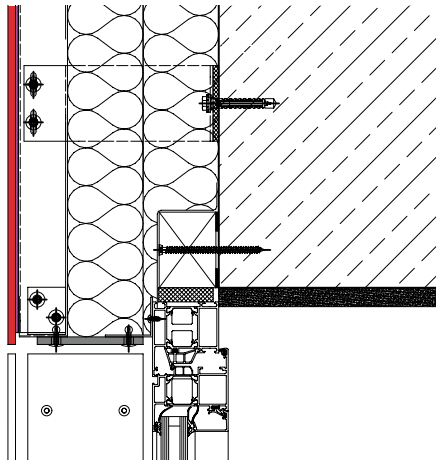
DETAILS KLEBEBEFESTIGUNG AUF METALLUNTERKONSTRUKTION
